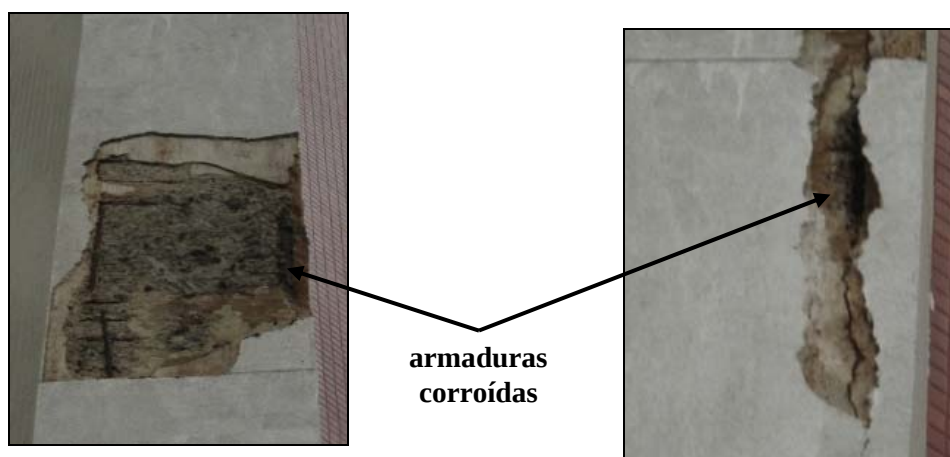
Destacamentos e fissuras nos pilares da fachada (Edifício 2)
